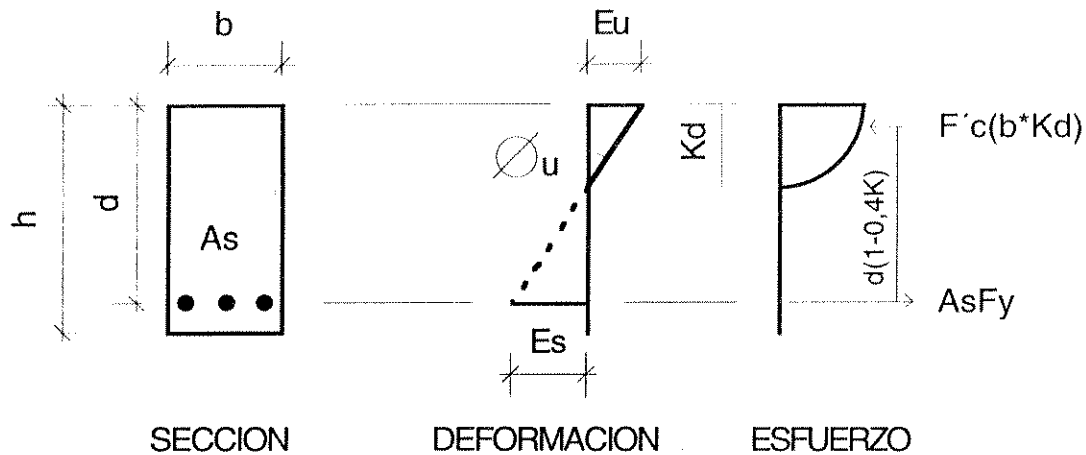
SECCION DE UNA VIGA SIMPLEMENTE REFORZADA A FLEXION BAJO MOMENTO ULTIMO.
